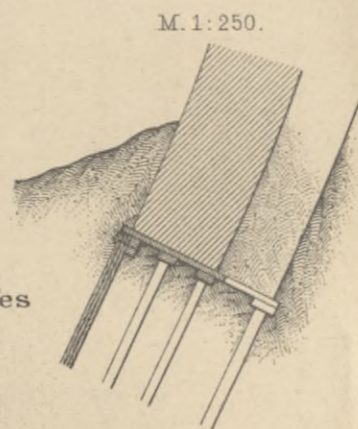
Widerlager der Donaubrücke bei Munderkingen. M. 1:200. A cross-sectional diagram of an abutment for the Danube Bridge at Munderkingen.
